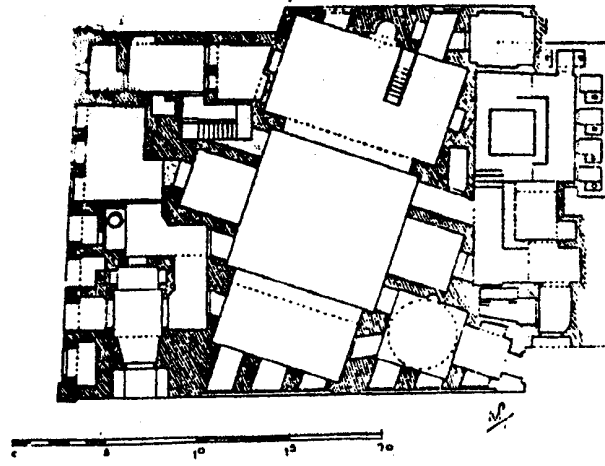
مسقط أفقي لمسجد أحمد المهندار بالقاهرة (عن : Creswell)
